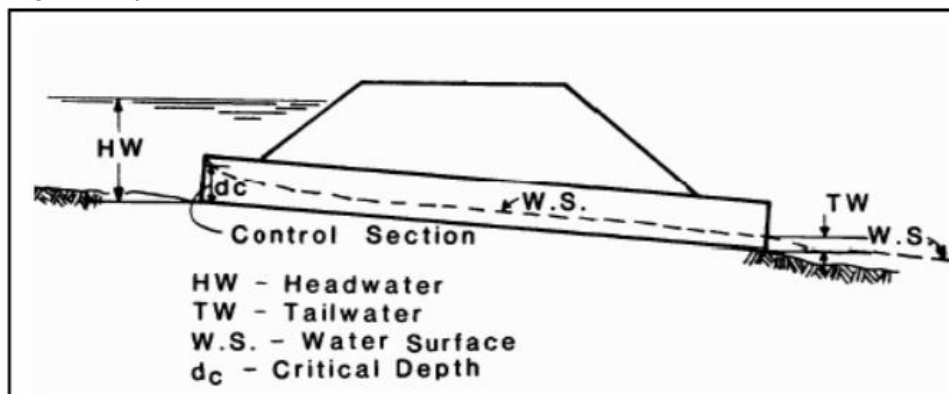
Esempio di moto controllato dalla sezione di ingresso
